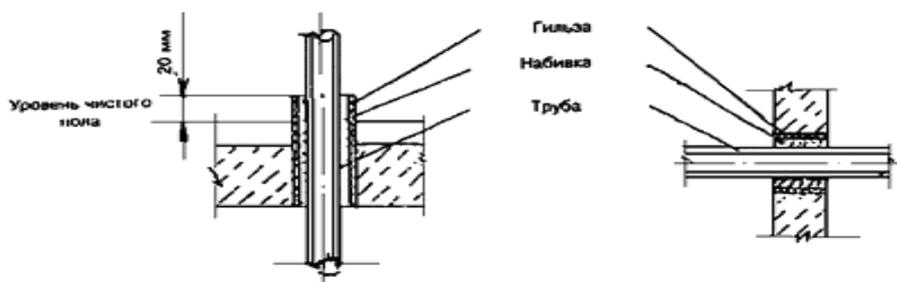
Установка гильзы для прокладки труб в стенах и покрытиях
